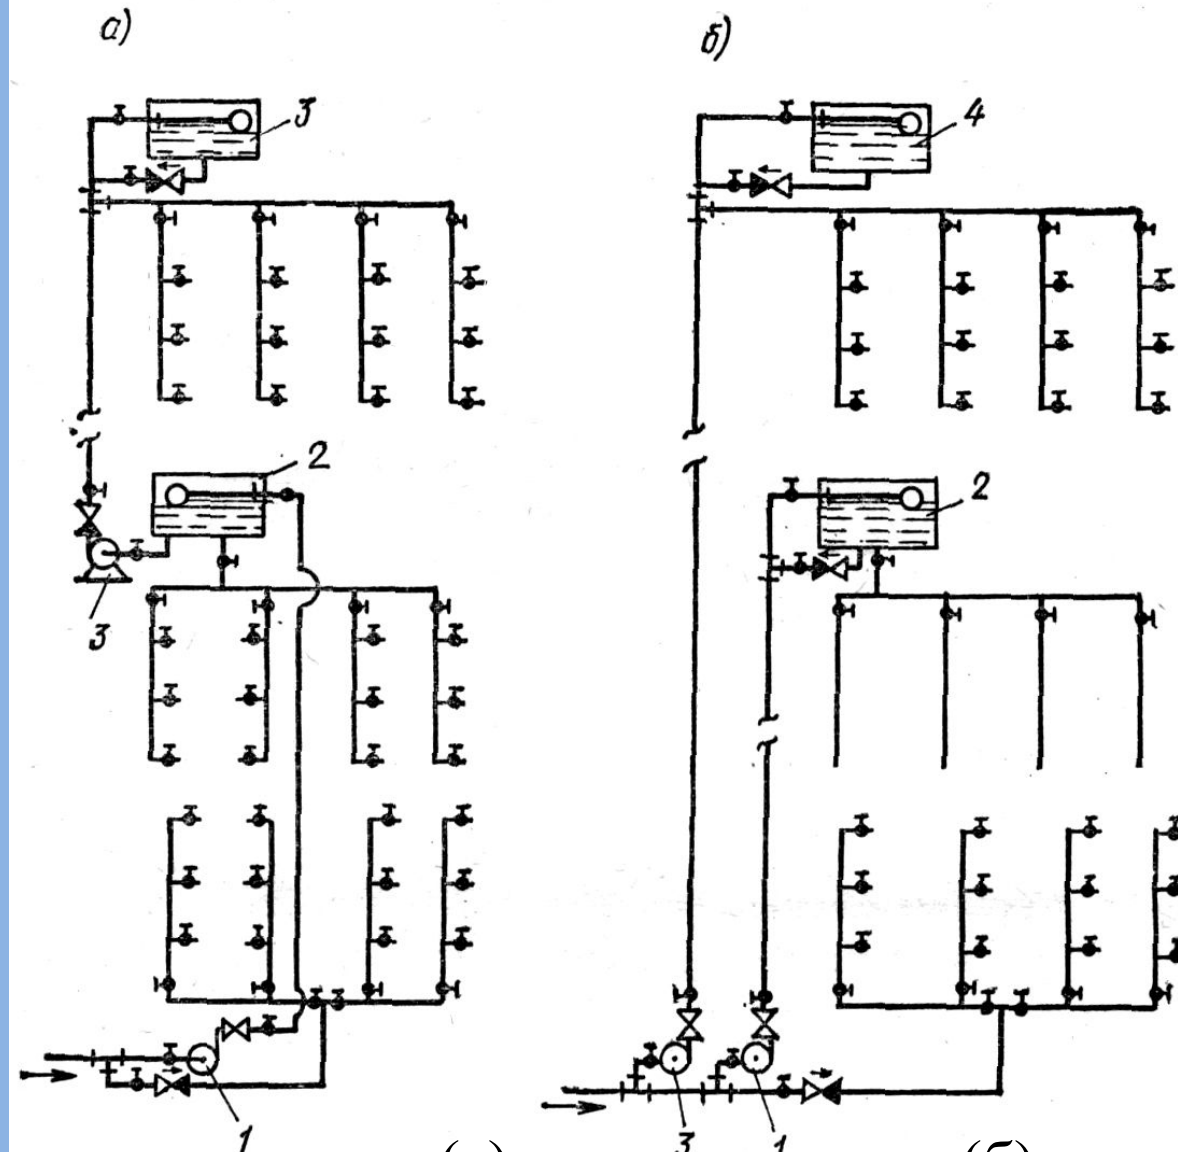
Последовательная (а) и параллельная (б) схемы зонных водопроводов зданий:
